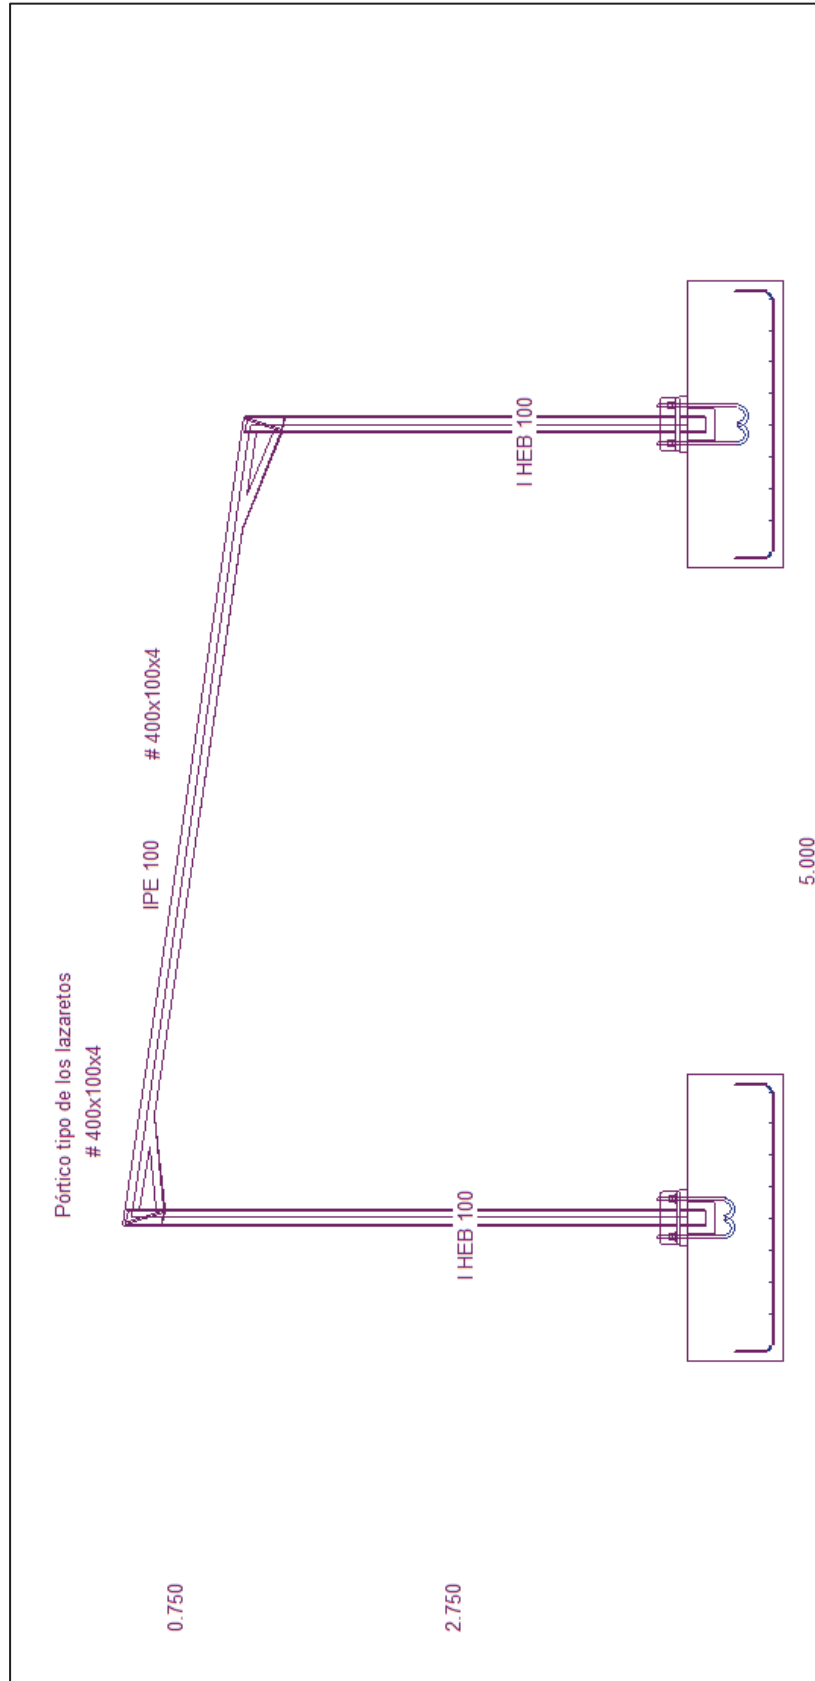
Detalle de los pórticos hastiales de los lazaretos.
